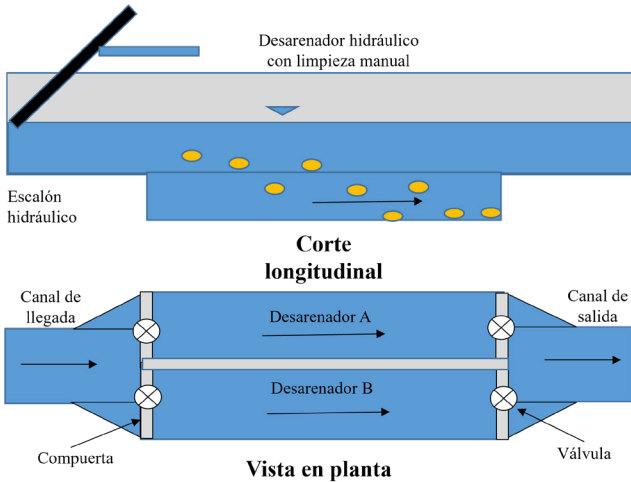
Corte longitudinal y vista en planta del desarenador hidráulico.
